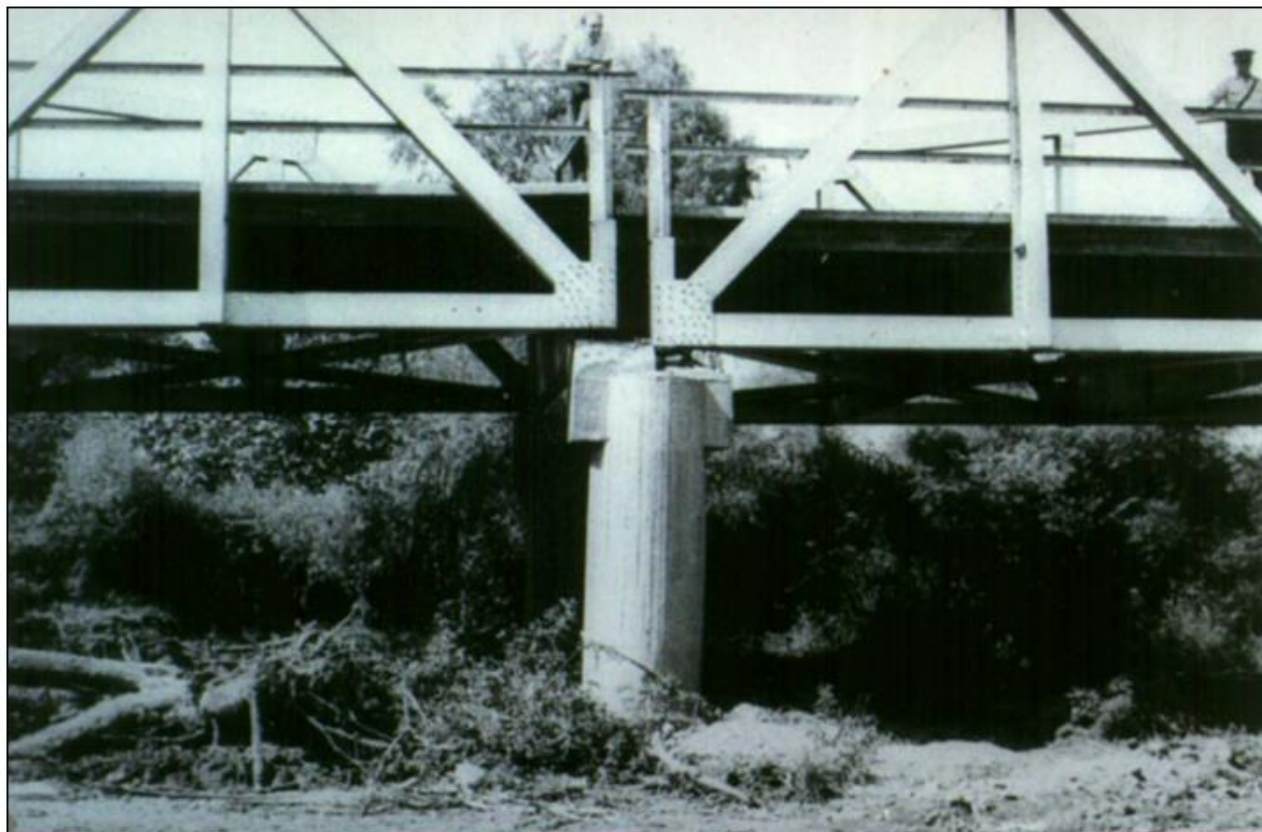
Puente Casma dañado por desplazamiento lateral del estribo izquierdo.
